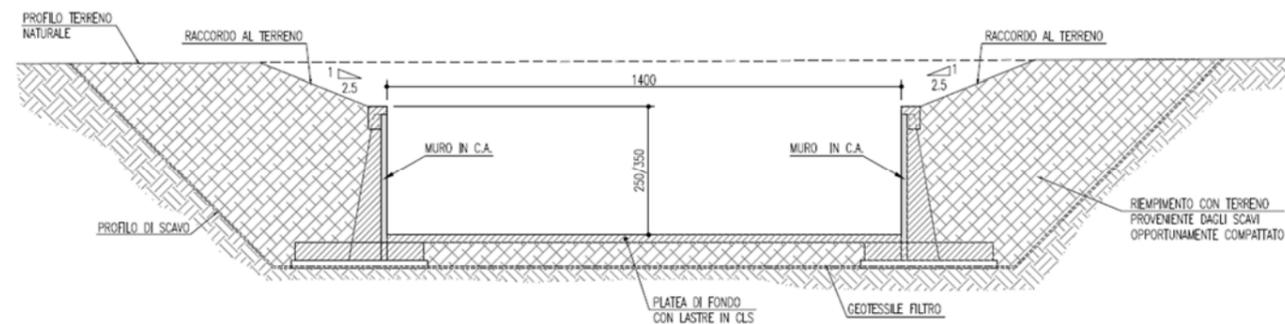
Sezione trasversale Canale Allacciante di Ponte Galeria – Tratto a cielo aperto
